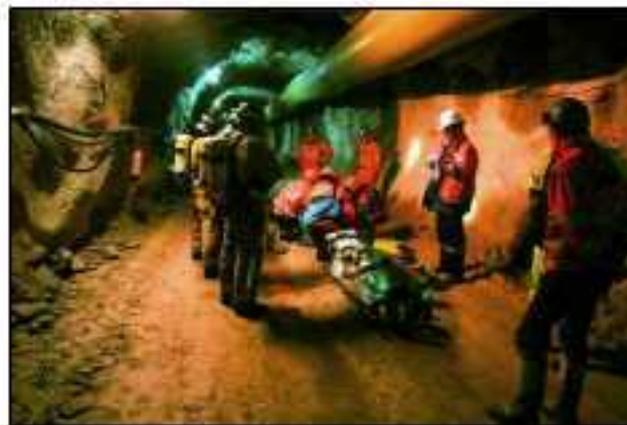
plan de emergencia – extracción Manual para la PRL OSALAN
